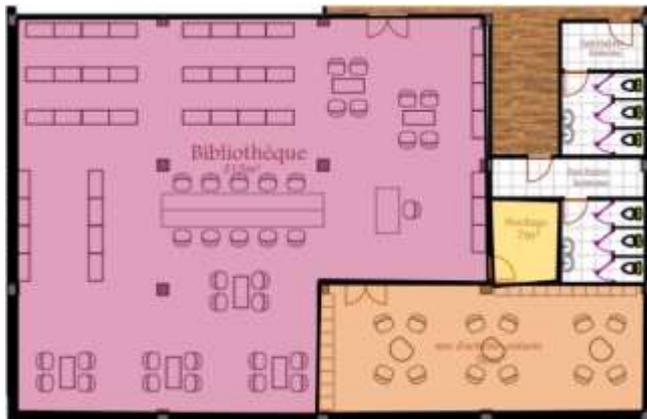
Plan de salle de jeux d'adolescent (Source : l'Auteur).
